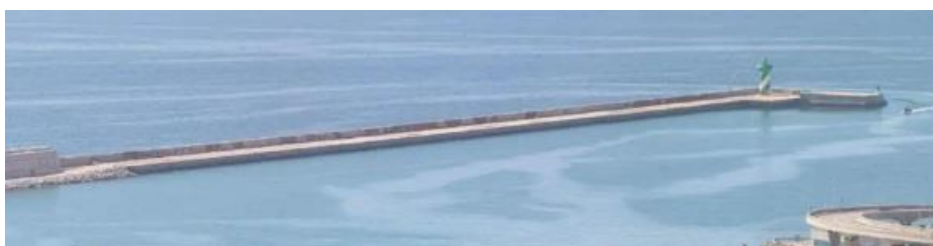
Zona de actuación del proyecto de rehabilitación del espaldón de la bocana Norte de Port de Barcelona.
